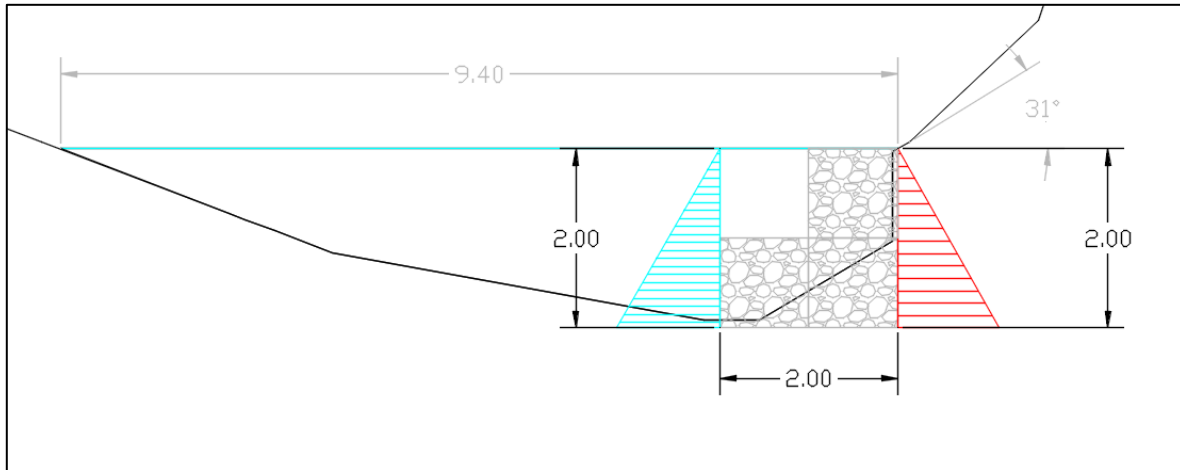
Sección 3, gavión tipo B. Fuente: Autor
